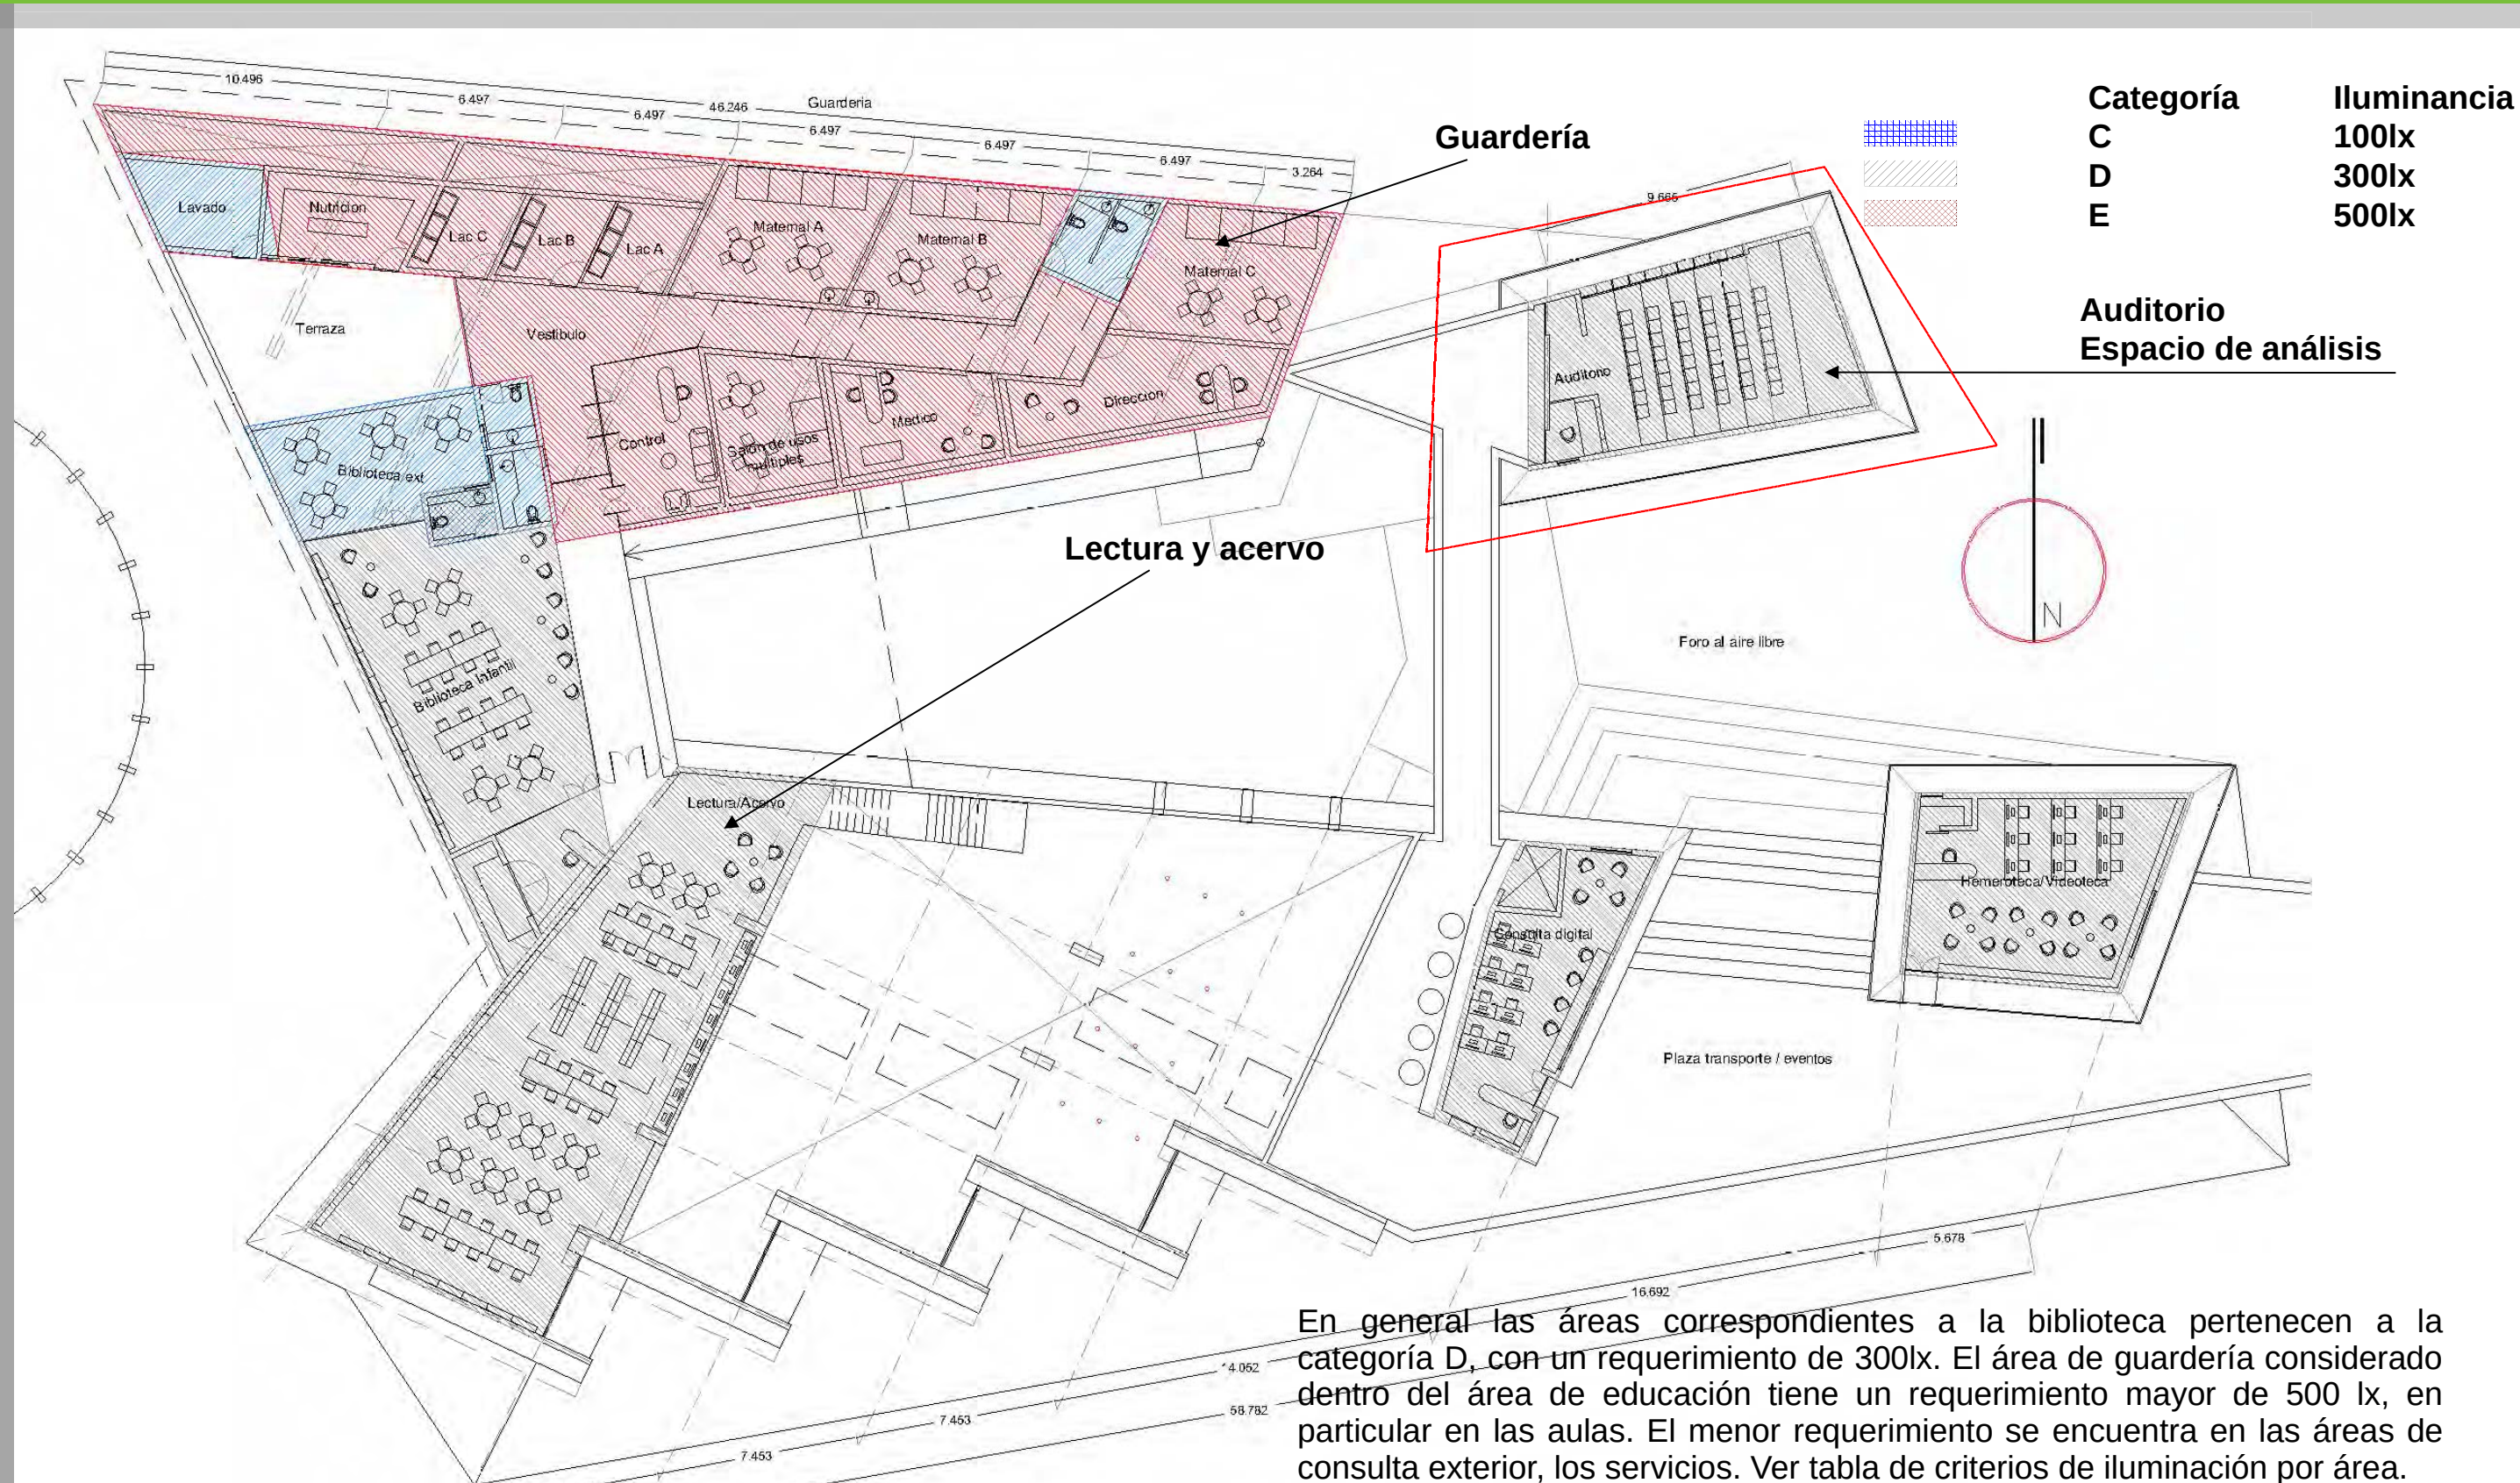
Planta Baja – Criterios de iluminación según IESNA
